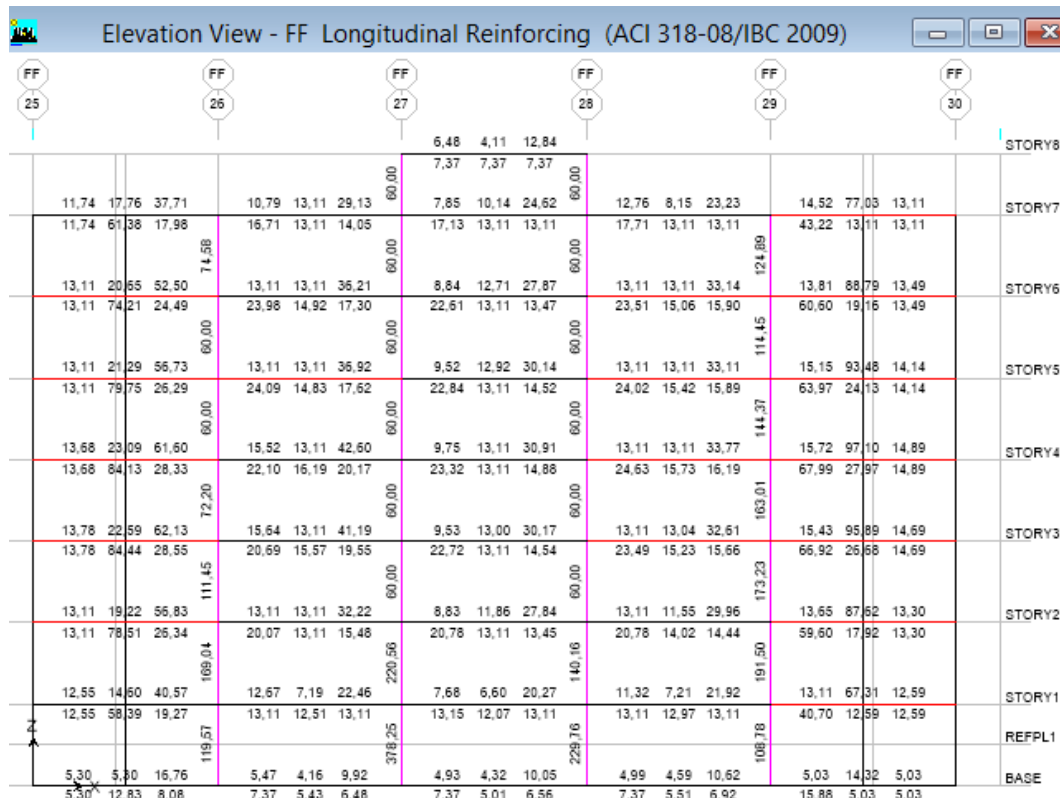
Acero en Vigas y Columnas en el Pórtico FF – Hospitalización 2- (LRB+HDR)
